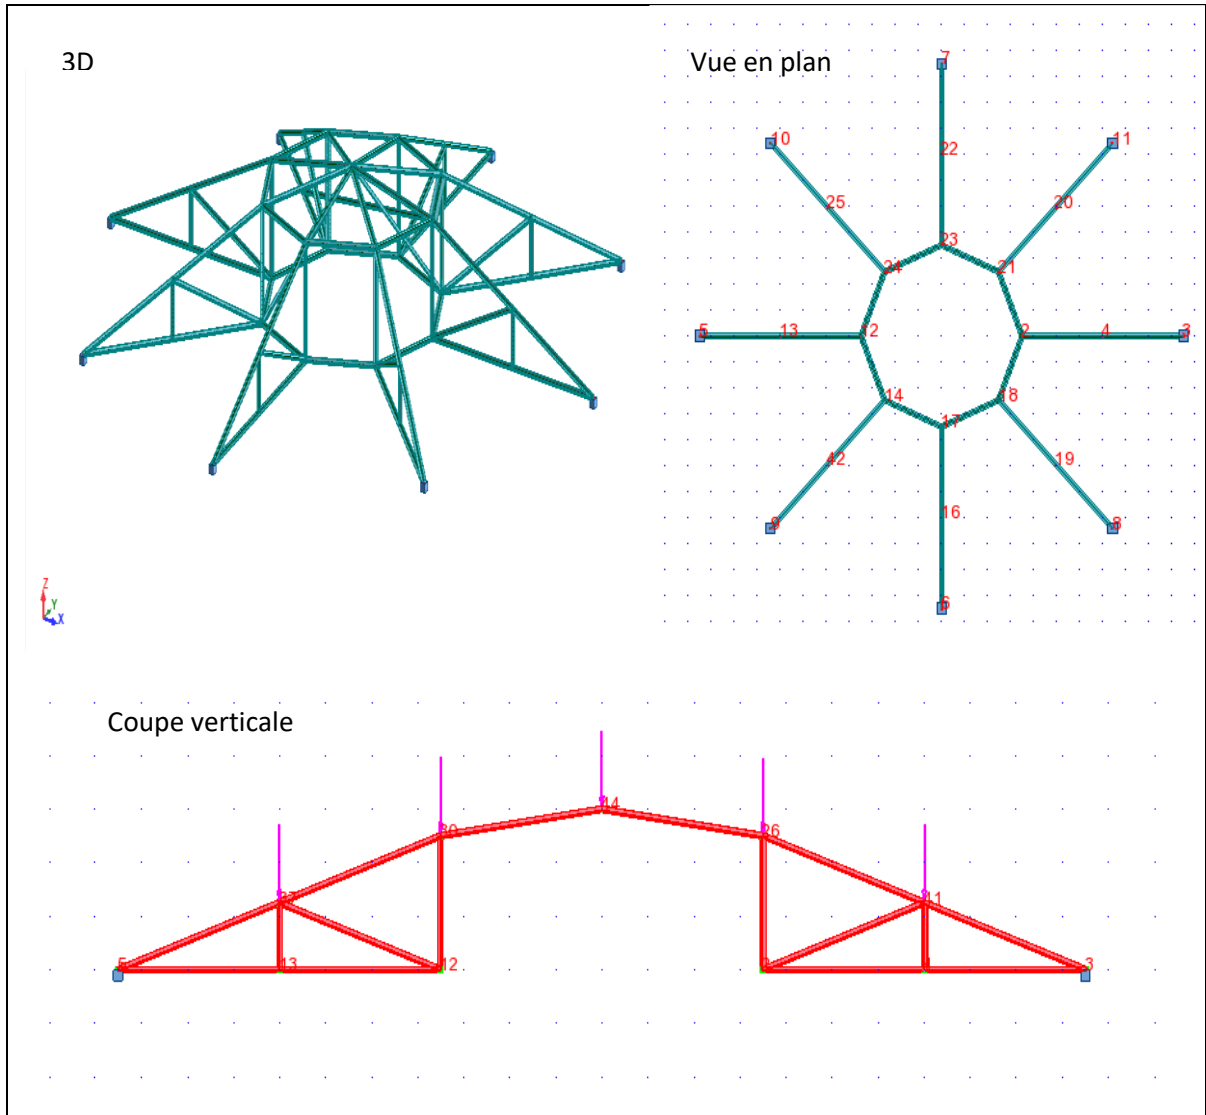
Vue générale de la structure (3D, coupe verticale, Vue en plan)
